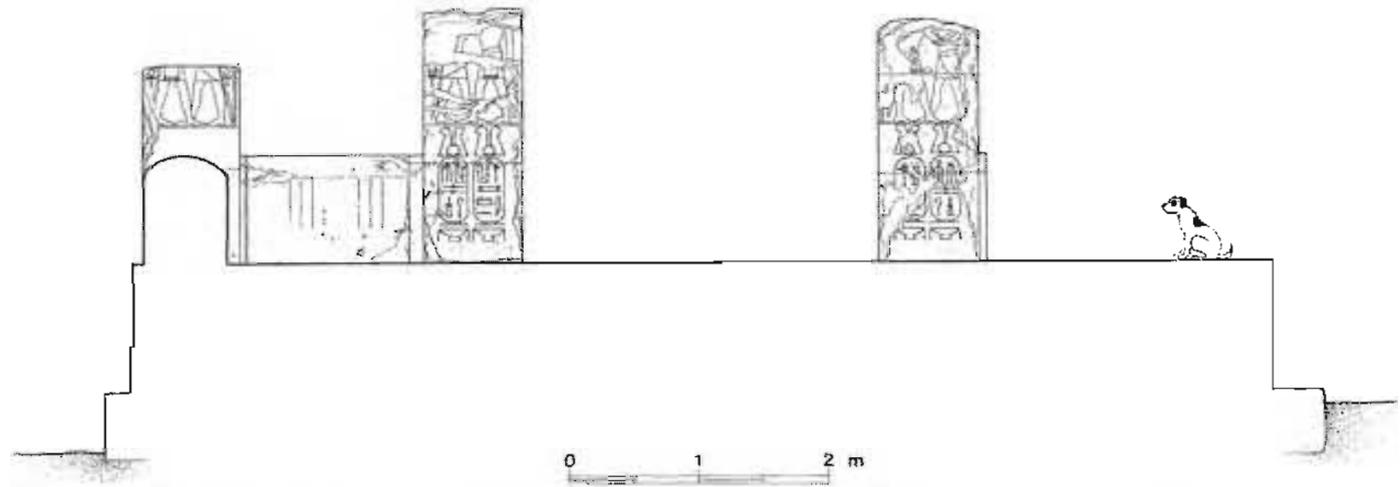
Coupe sur la galerie méridionale vers le sud.
